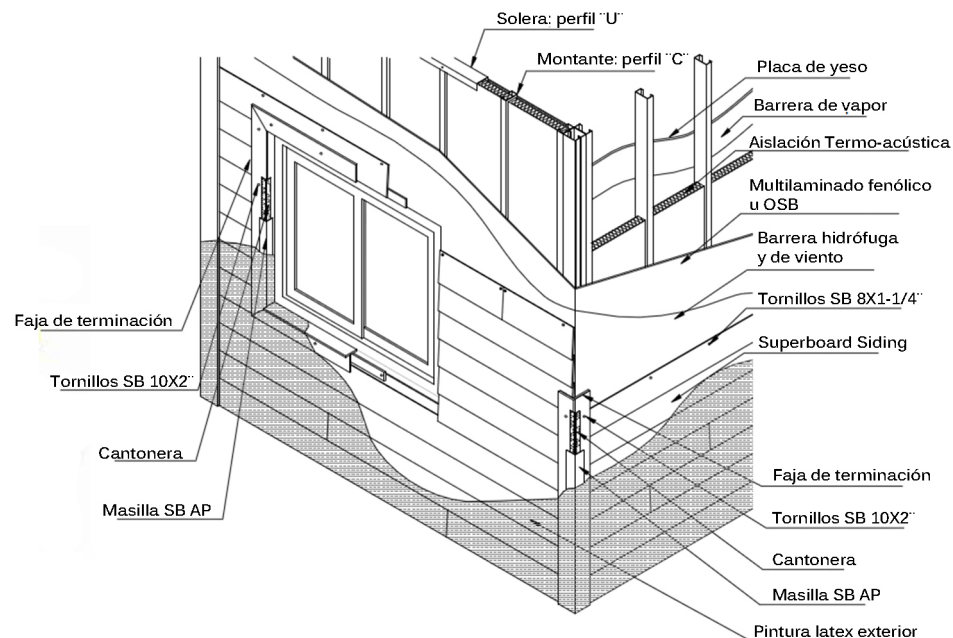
Detalle de revestimiento con siding cementicio.
